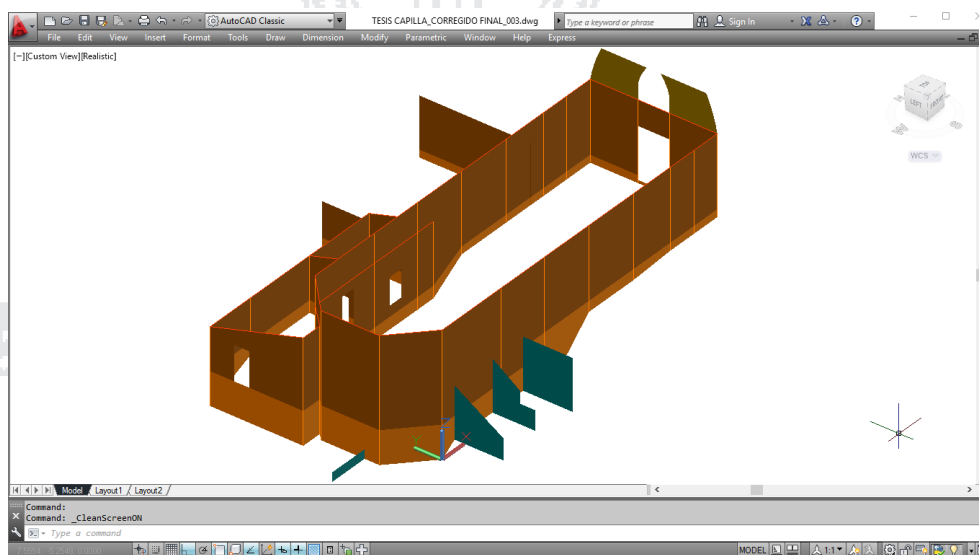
Geometría de la estructura en AUTOCAD 3D.
